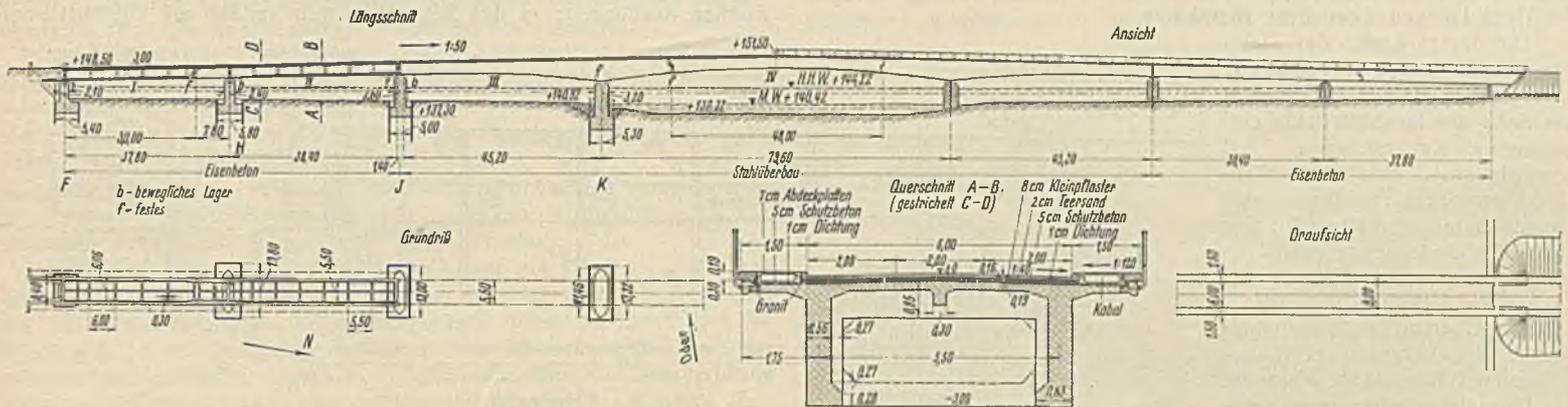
Ausführungsentwurf, Längsschnitt, Ansicht, Querschnitt, Grundriß.
